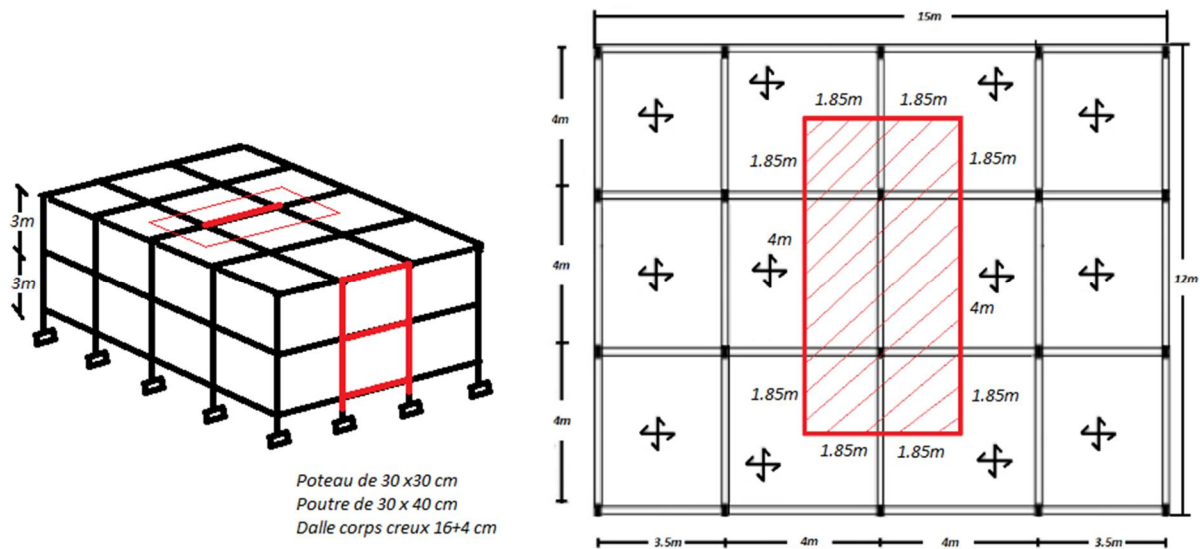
4 : Vu en plan et en élévation de la structure étudiée
